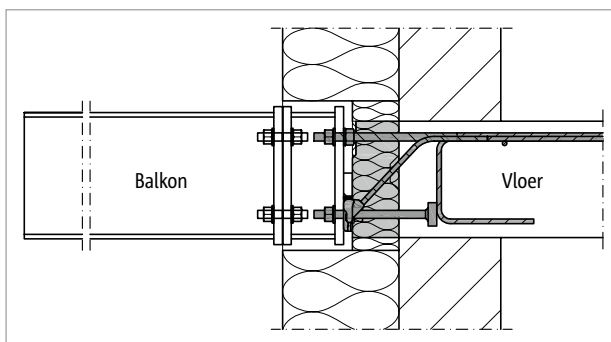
Schöck Isokorf® T type SK: barrièrevrije overgang door hogere positionering
